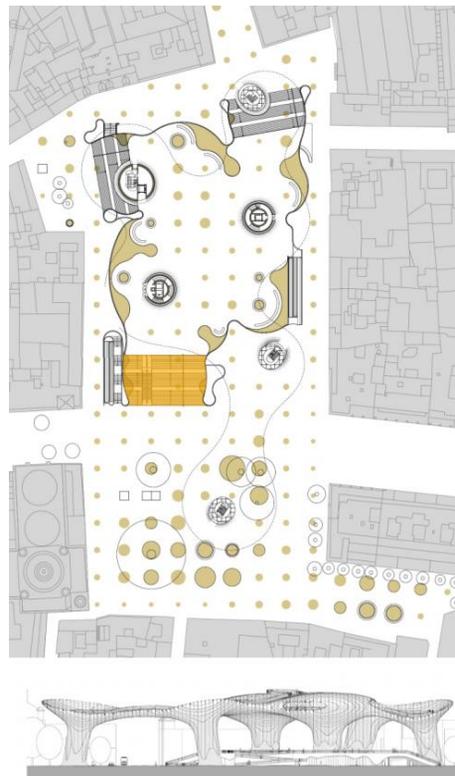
Planta cota +3.50 y sección del proyecto Metropol Parasol. Jürgen Mayer Architects (2006).
